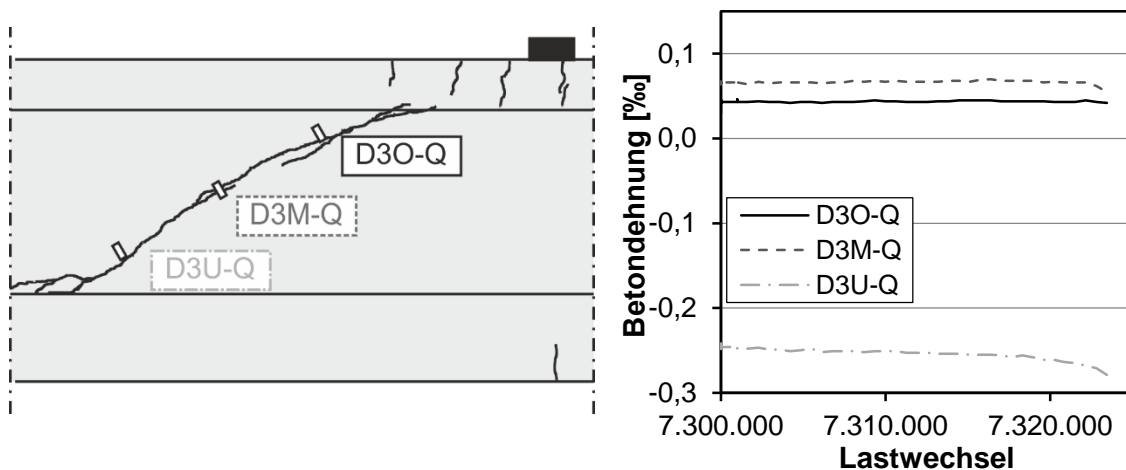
Versuch I-0-1b: a) Lage der DMS; b) Betondehnungen unter Oberlast
